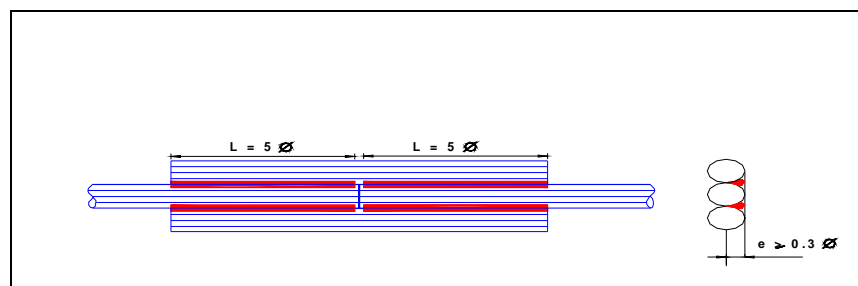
Refuerzo del acero con soldadura filete de un lado (Do Lago 1997)
